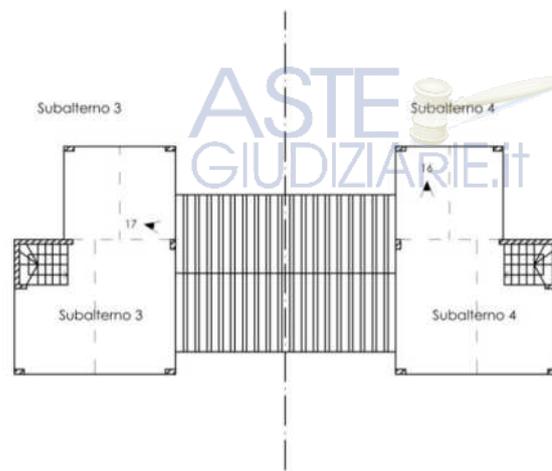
Schema planimetrico piano T come da allegato 11b alla presente relazione.
